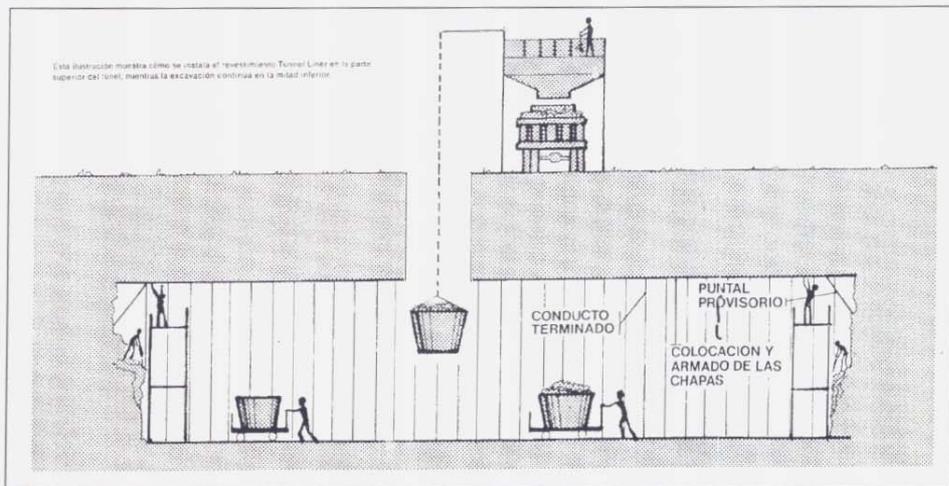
Instalación de un túnel con chapa de acero corrugado
